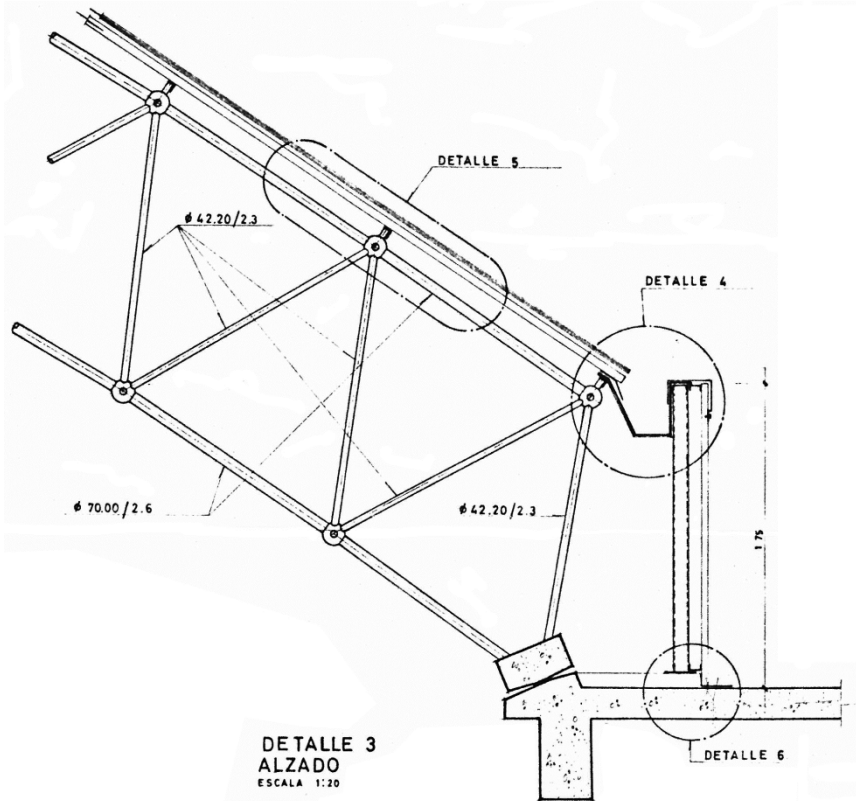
Detalle del apoyo de la estructura espacial sobre una de las dos galerías longitudinales de hormigón, mediante la disposición de una rótula plástica.
